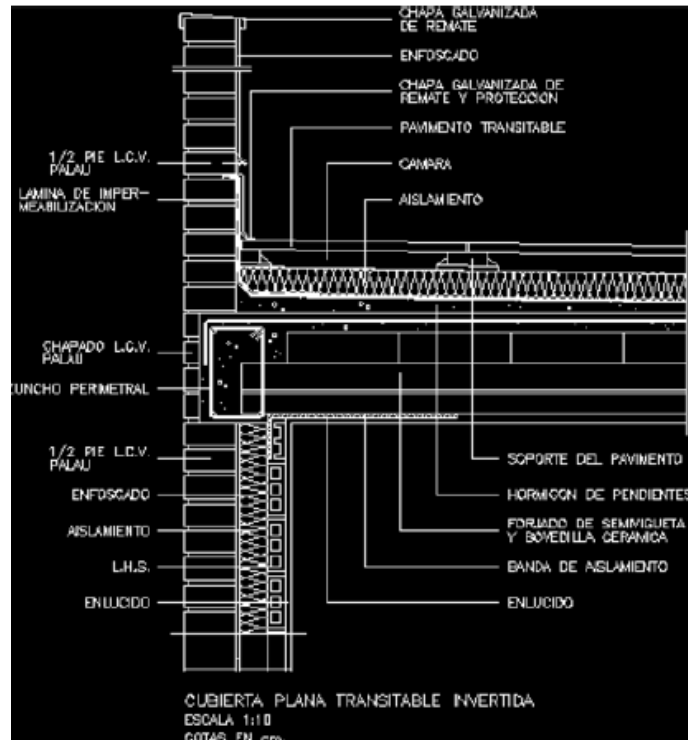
DETALLE CUBIERTA PLANA INVERTIDA
